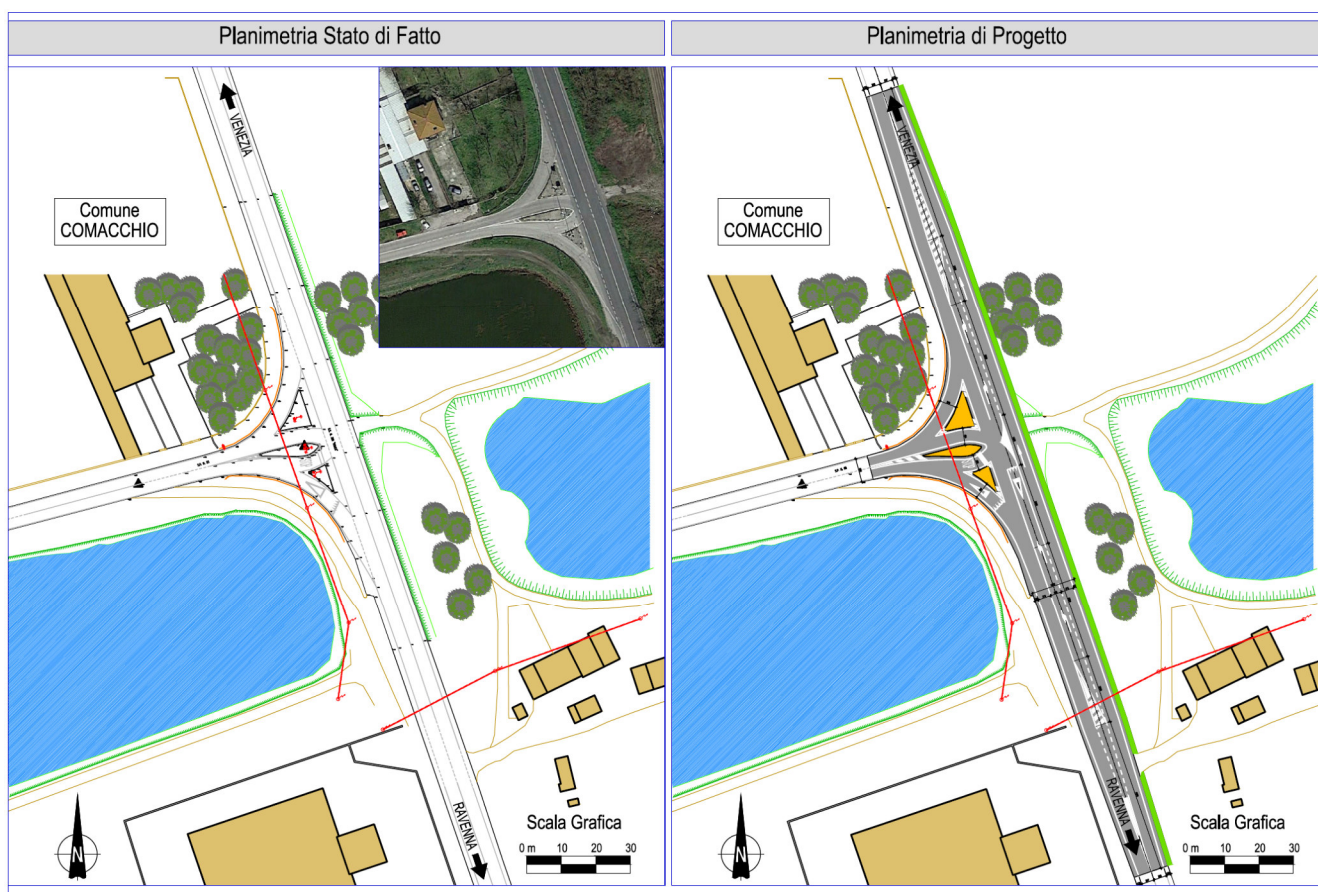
Intervento n° 15 – Planimetria Stato di fatto - Progetto
